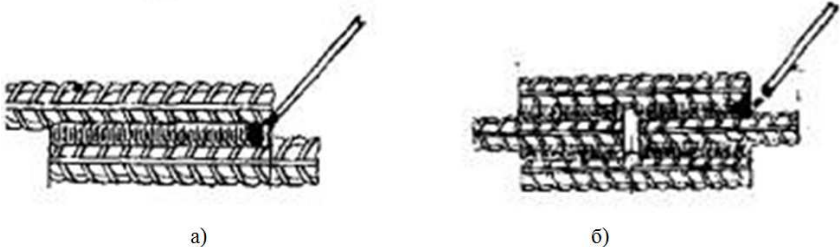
Дугове зварювання: а) зварювання внахлест;
